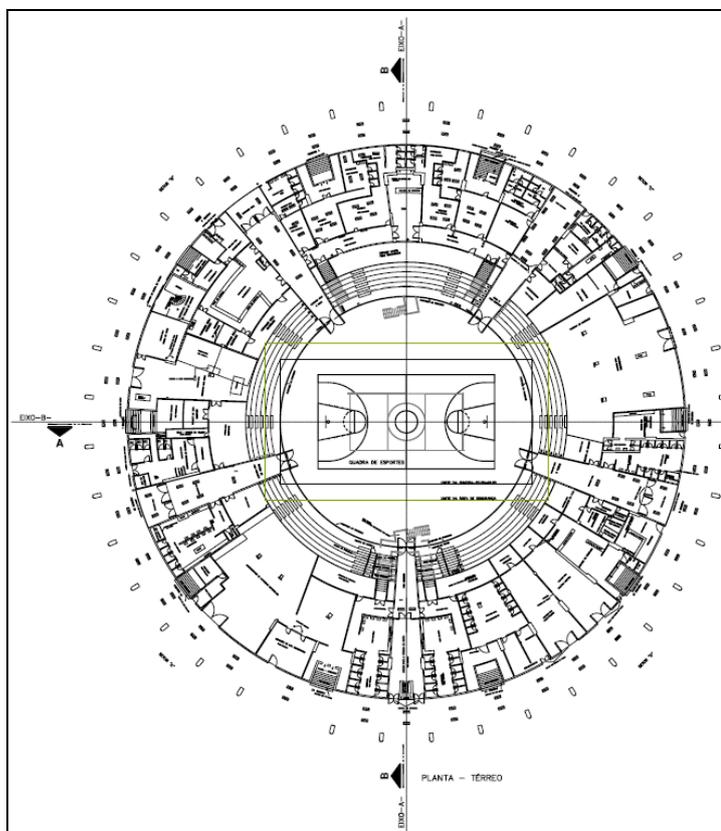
Planta baixa térreo – Ginásio Geraldo José de Almeida (Ibirapuera)
